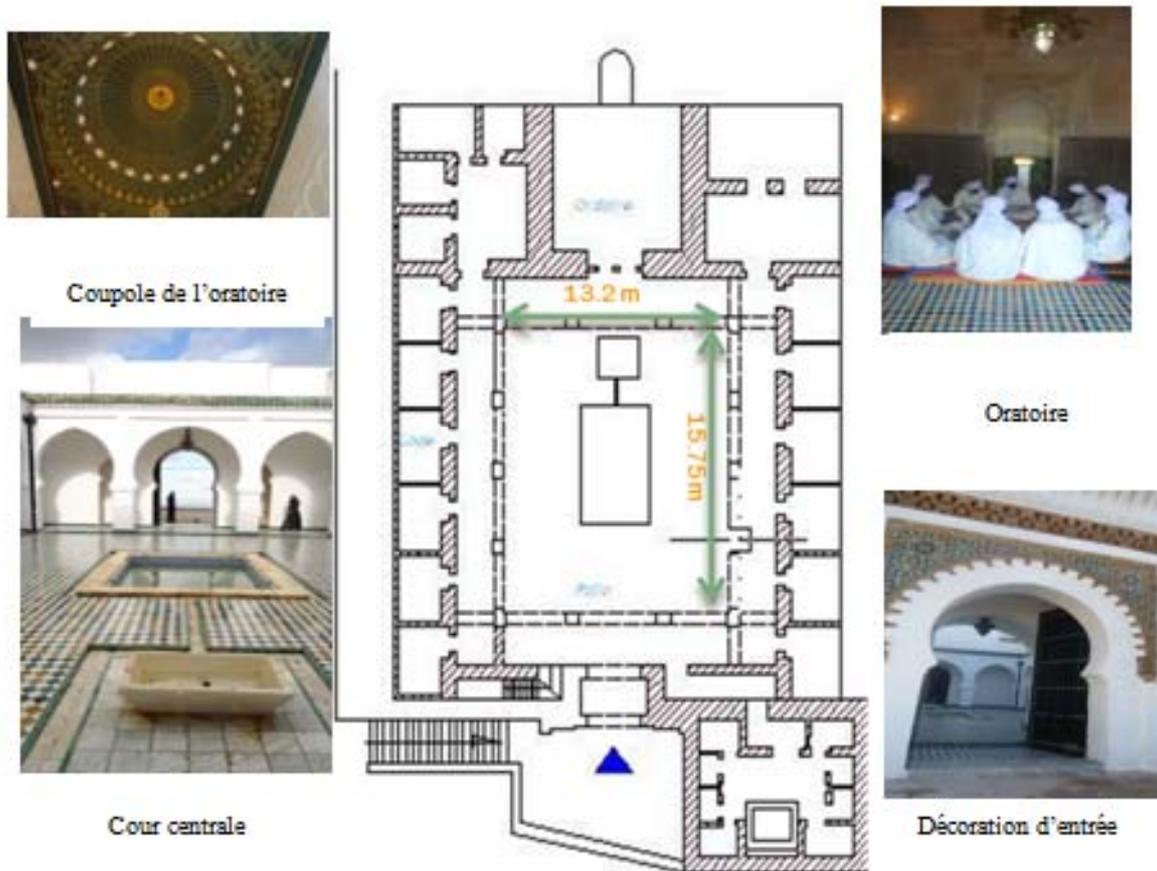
plan de distribution spatiale de Rez De Chaussée
